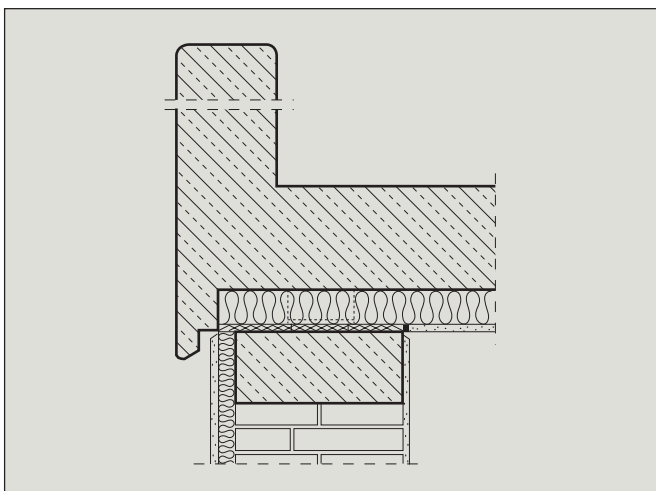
Auflagerung eines wu-Beton-Daches mit unterseitiger Dämmung auf Punktlagern
